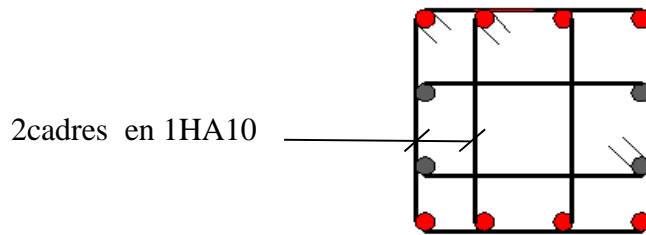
Armatures transversales des Poteaux des Niveaux 3 à 5
